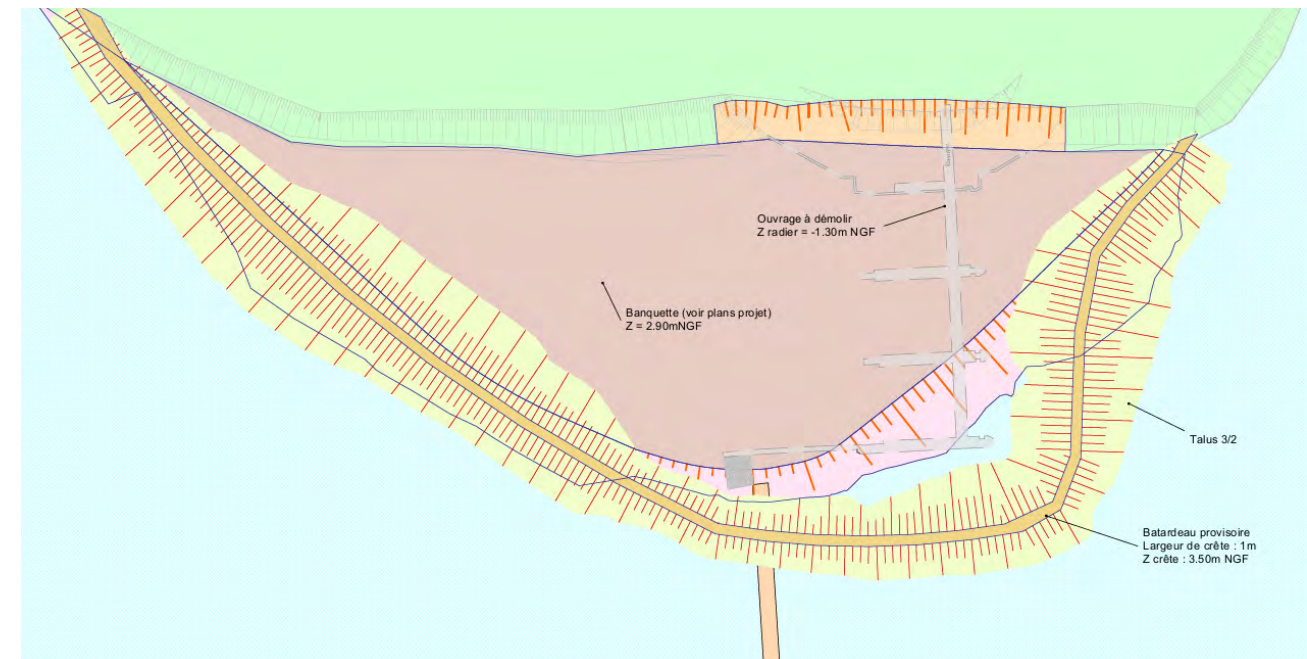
Extrait de la vue en plan de l'implantation du batardeau (source : SCE)
